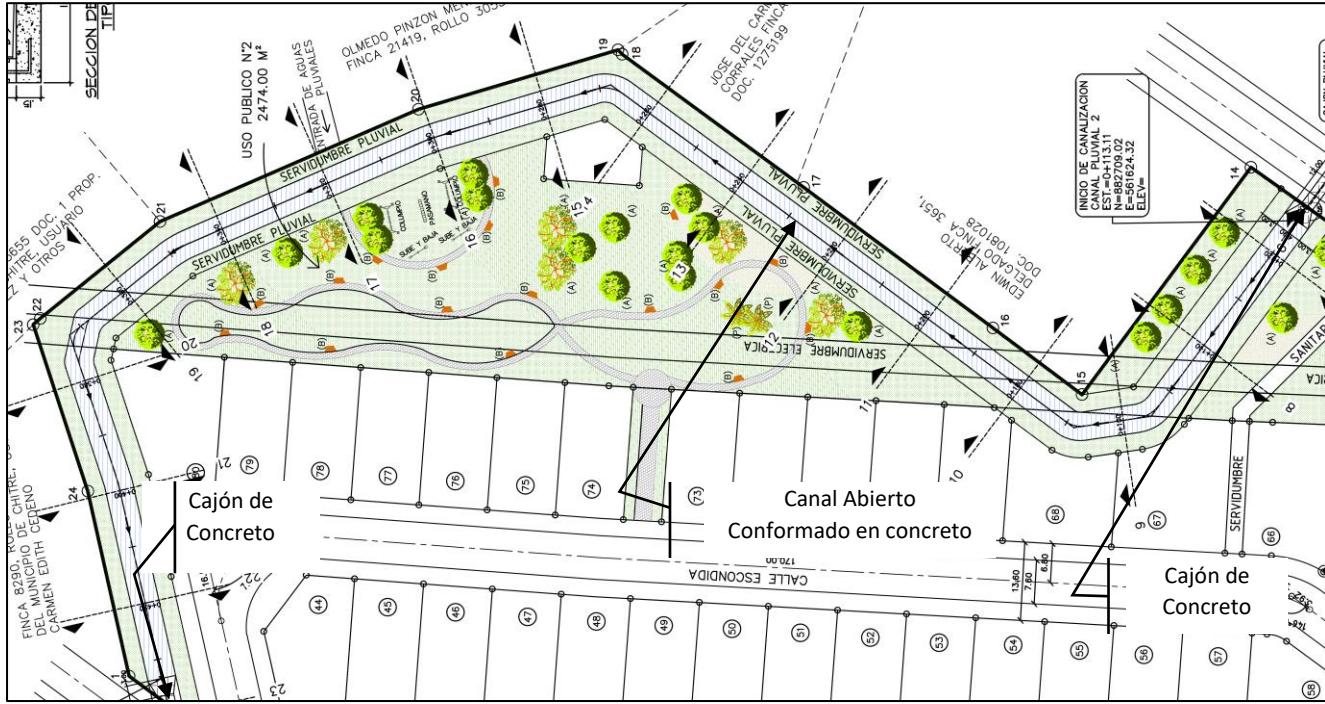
Extracto del pre-diseño del drenaje pluvial “Sin Nombre 2”, donde se ilustra las secciones de Cajón y Canal abierto en concreto.
